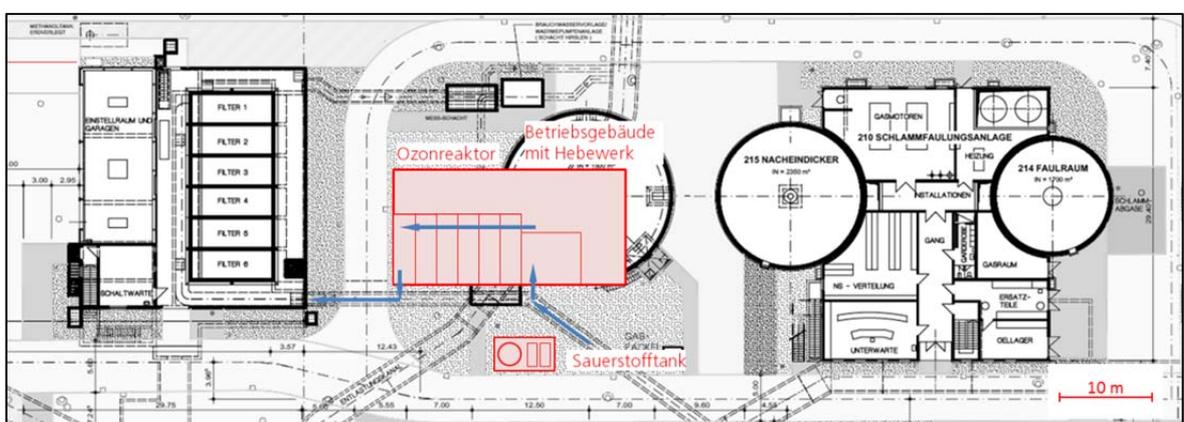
Planskizze Layout Ozonung mit Sandfiltration
